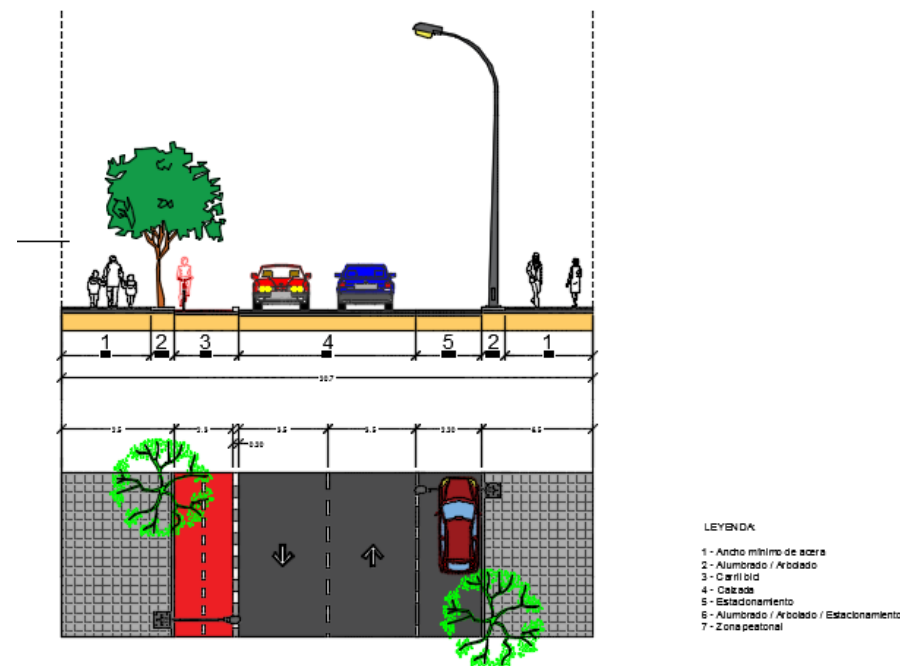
Avenida Camp de Morvedre. Sección tras la actuación.
